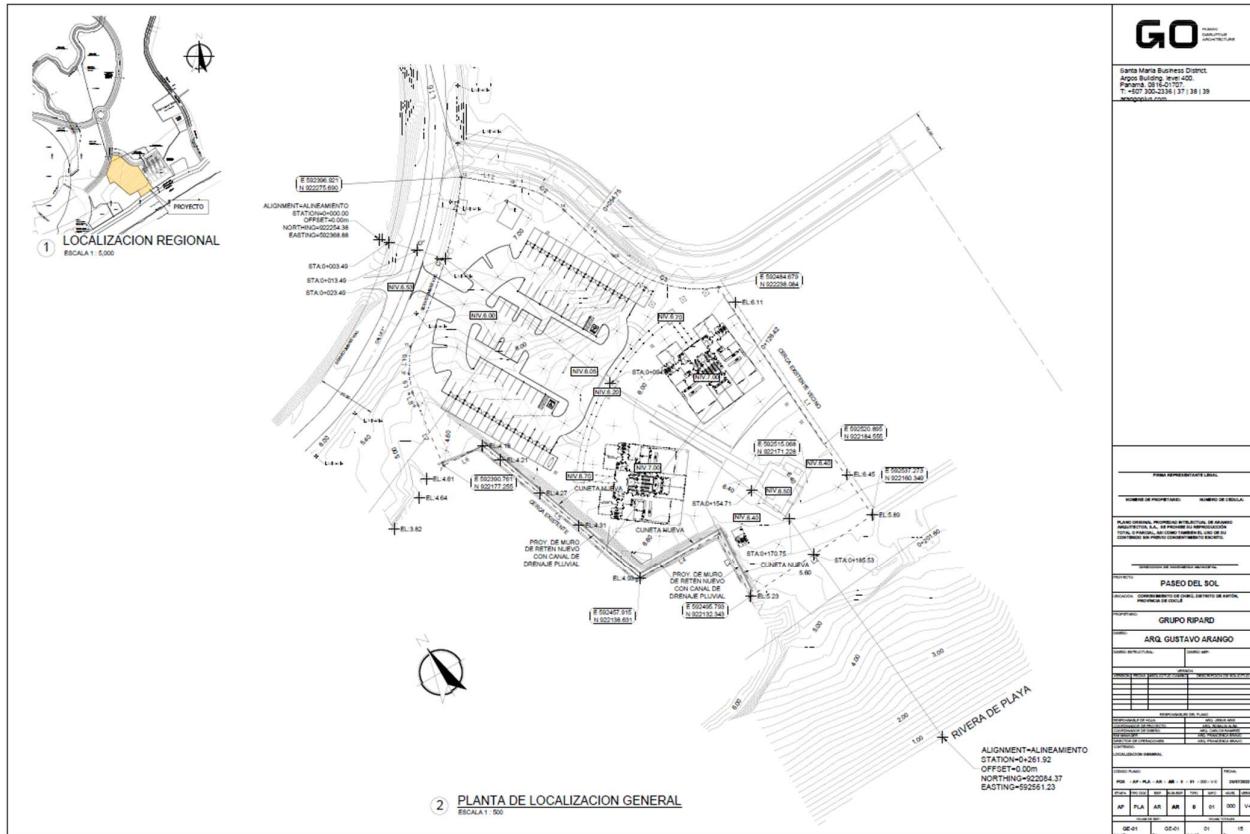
Topografía del terreno, en la sección de anexos se puede apreciar el plano topográfico a escala.
